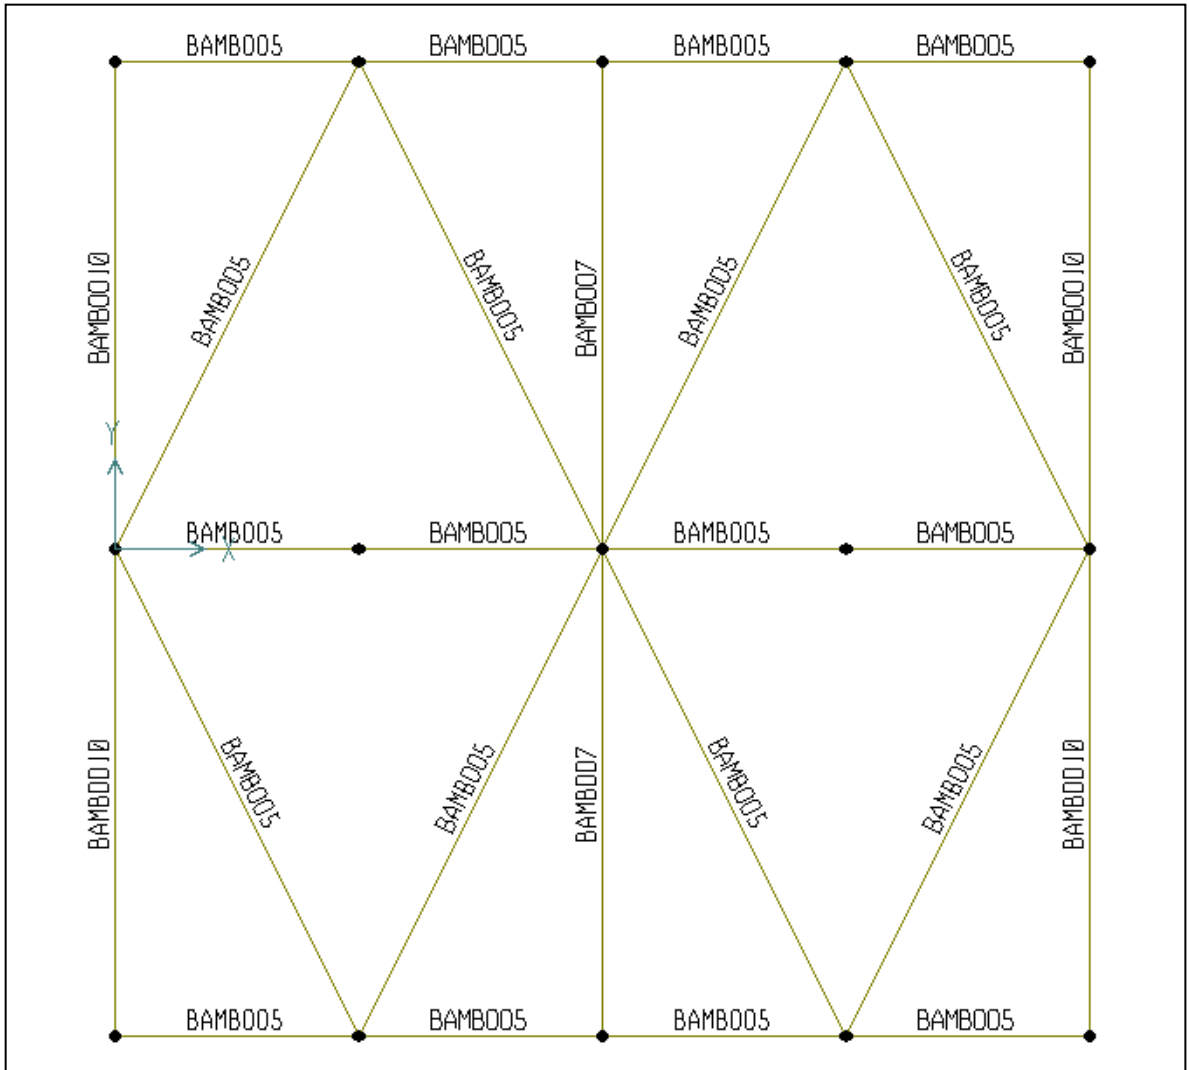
Diámetro de los elementos de la estructura en el plano xy, altura a canoa.
